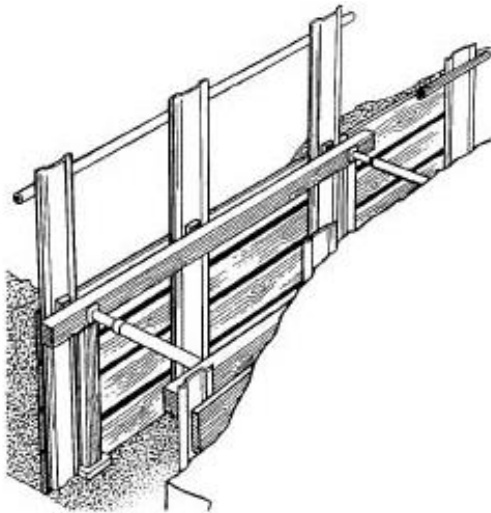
Apuntalamiento de excavación, protección para evitar caídas dentro de la excavación
